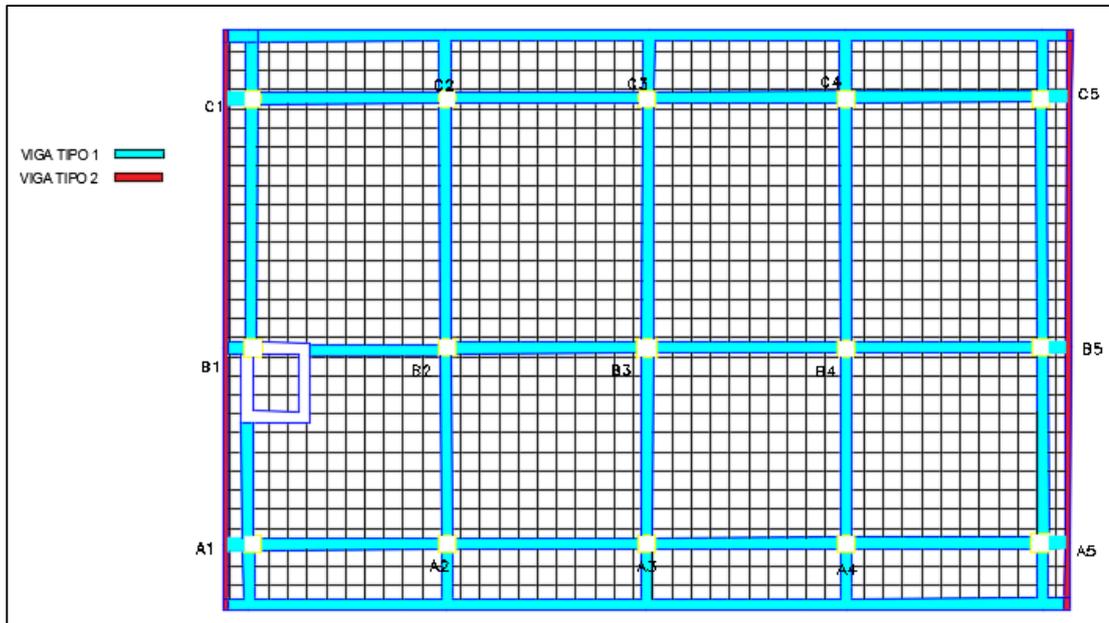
Esquema de distribución de vigas tipo N+8,10 (Hormigón)
